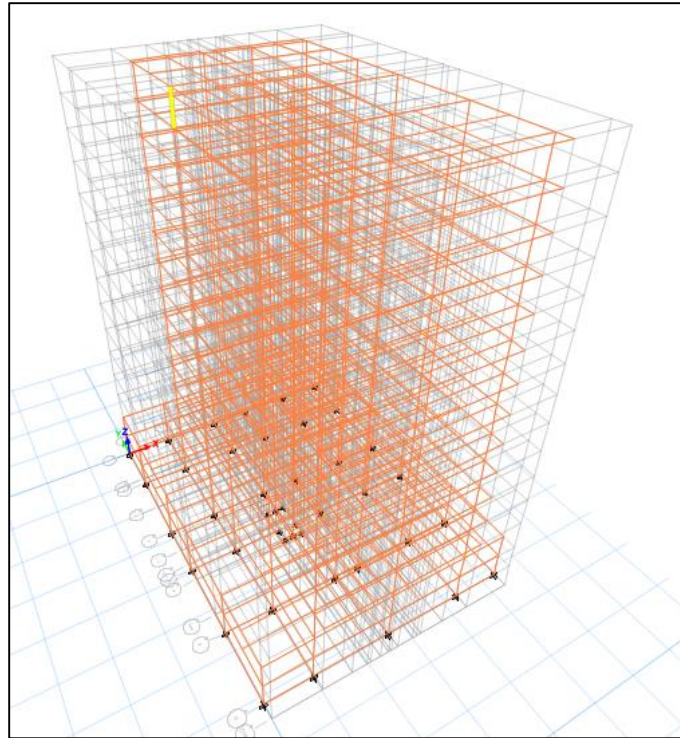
Columna B3 tipo 4 de 60x40cm Story 15.
